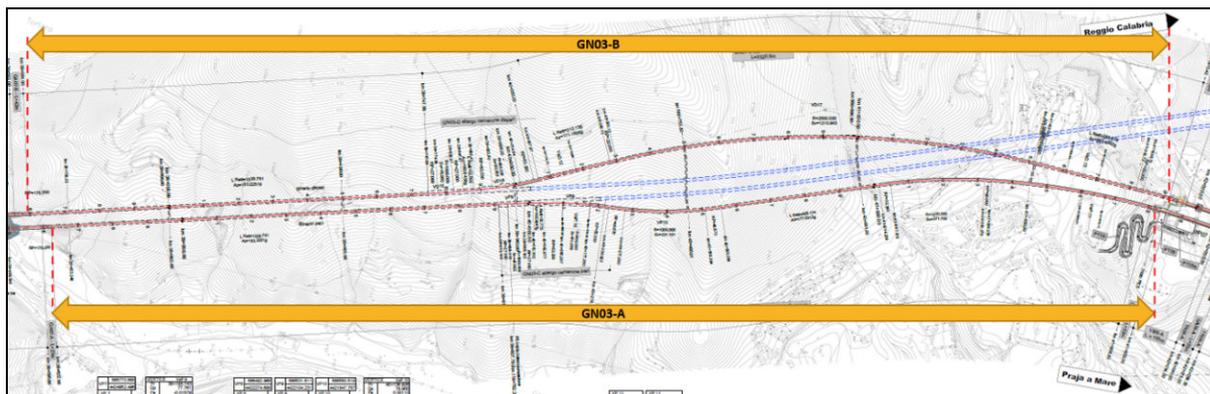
Planimetria di progetto gallerie GN03-A/B da km 38+595 al km 41+859 BP
